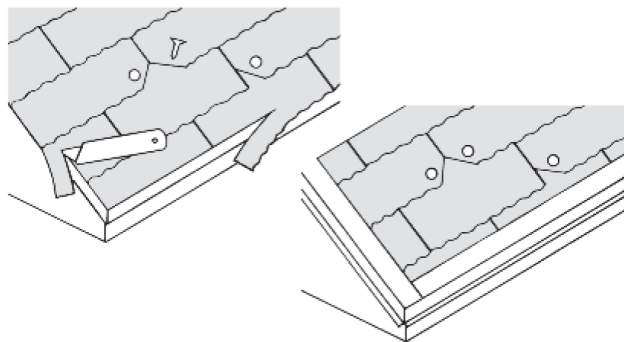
Подготовка старой кровли к укладке нового гонта.
